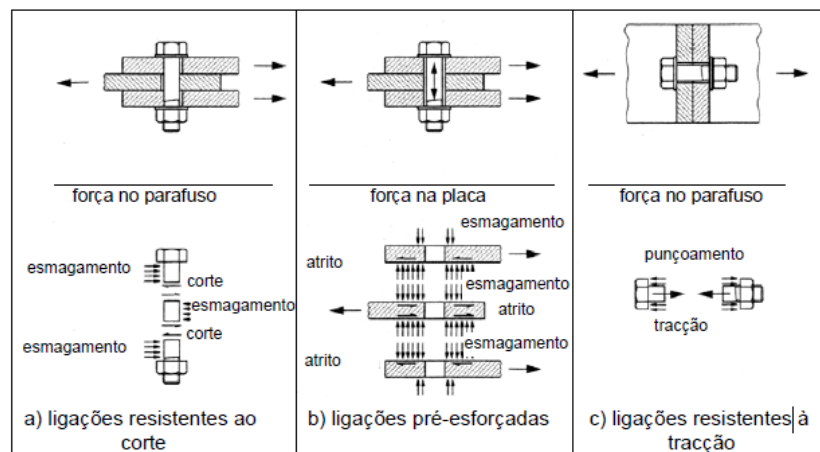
Distribuição de forças em ligações aparafusadas sujeitas ao corte e em ligação aparafusadas pré-esforçadas (Simões & Santiago, 2003).
